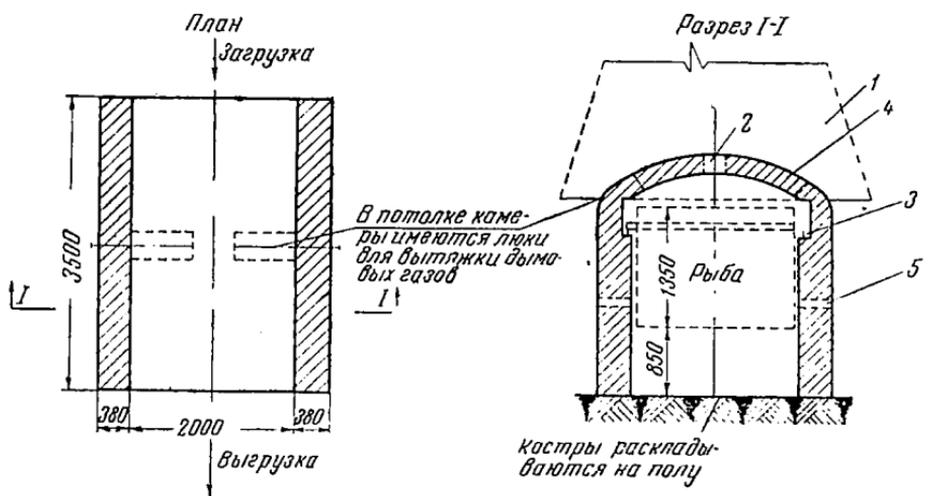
Печь нового рижского типа для горячего копчения рыбы: 1—вытяжной зонт; 2—люки; 3—стойки для рам с рыбой; 4—потолок; 5—резервные люки.
